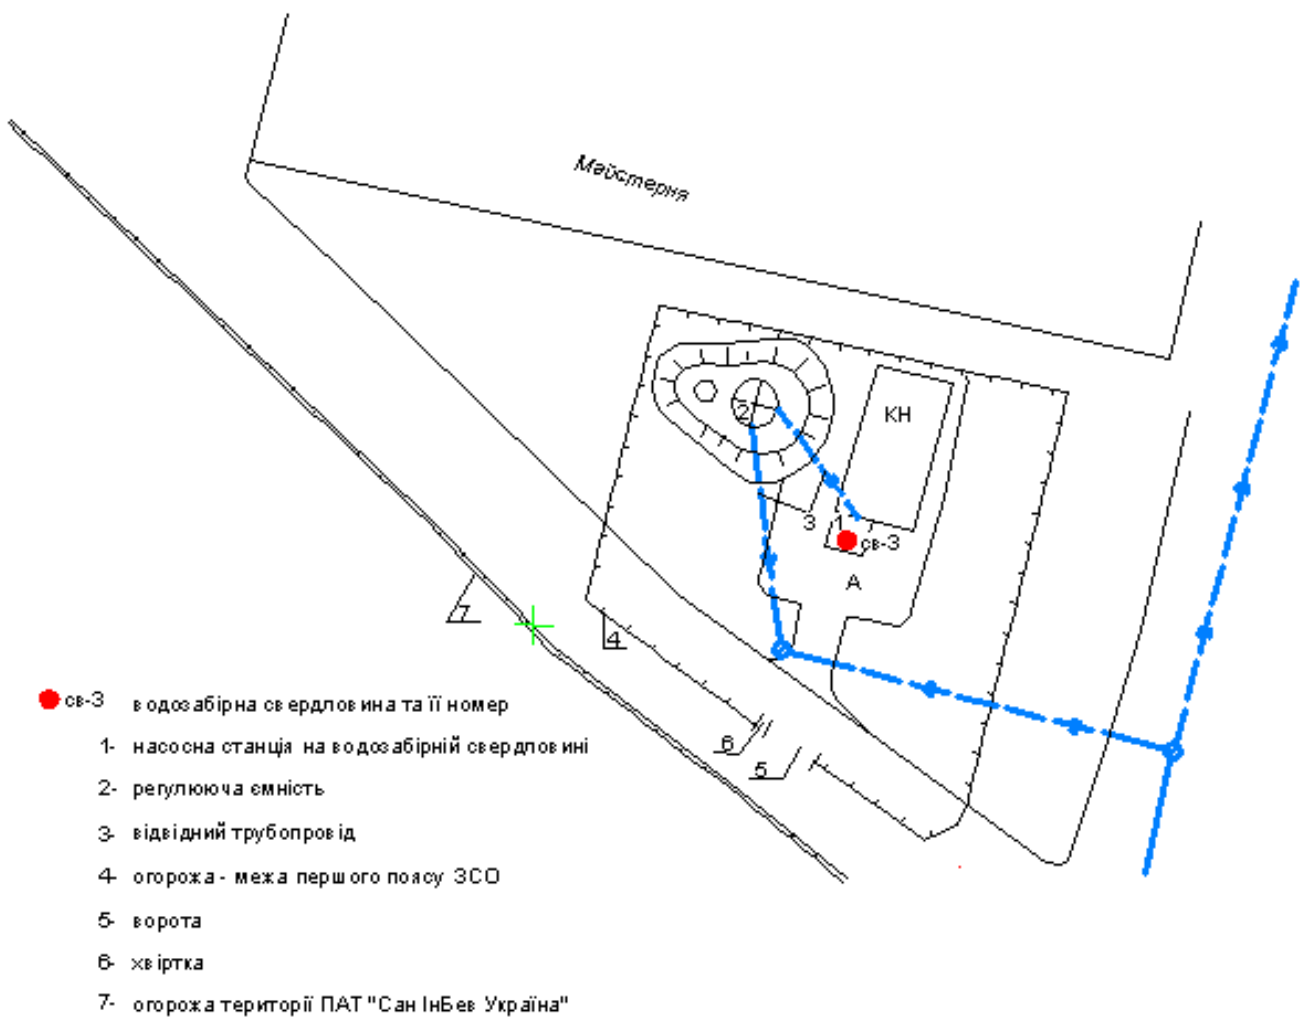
План першого поясу зони санітарної охорони свердловини 3
